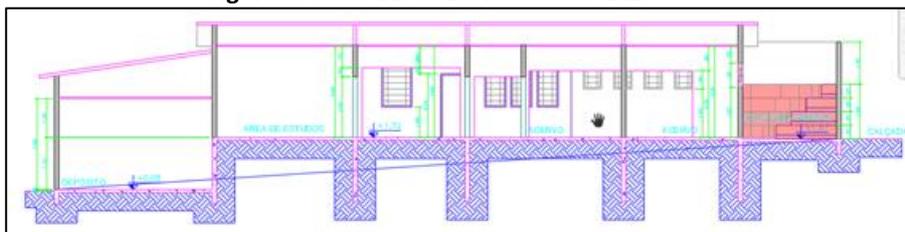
Elevação 02 da Biblioteca do IEEL.
